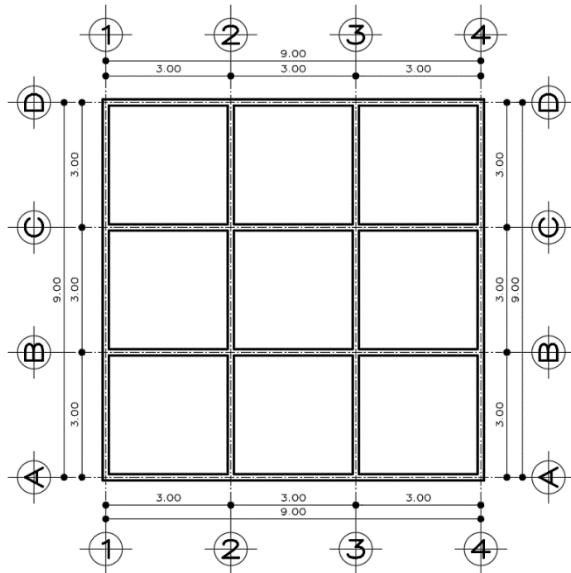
Planta tipo para modelos de análisis con dimensiones de 9x9 mts.
